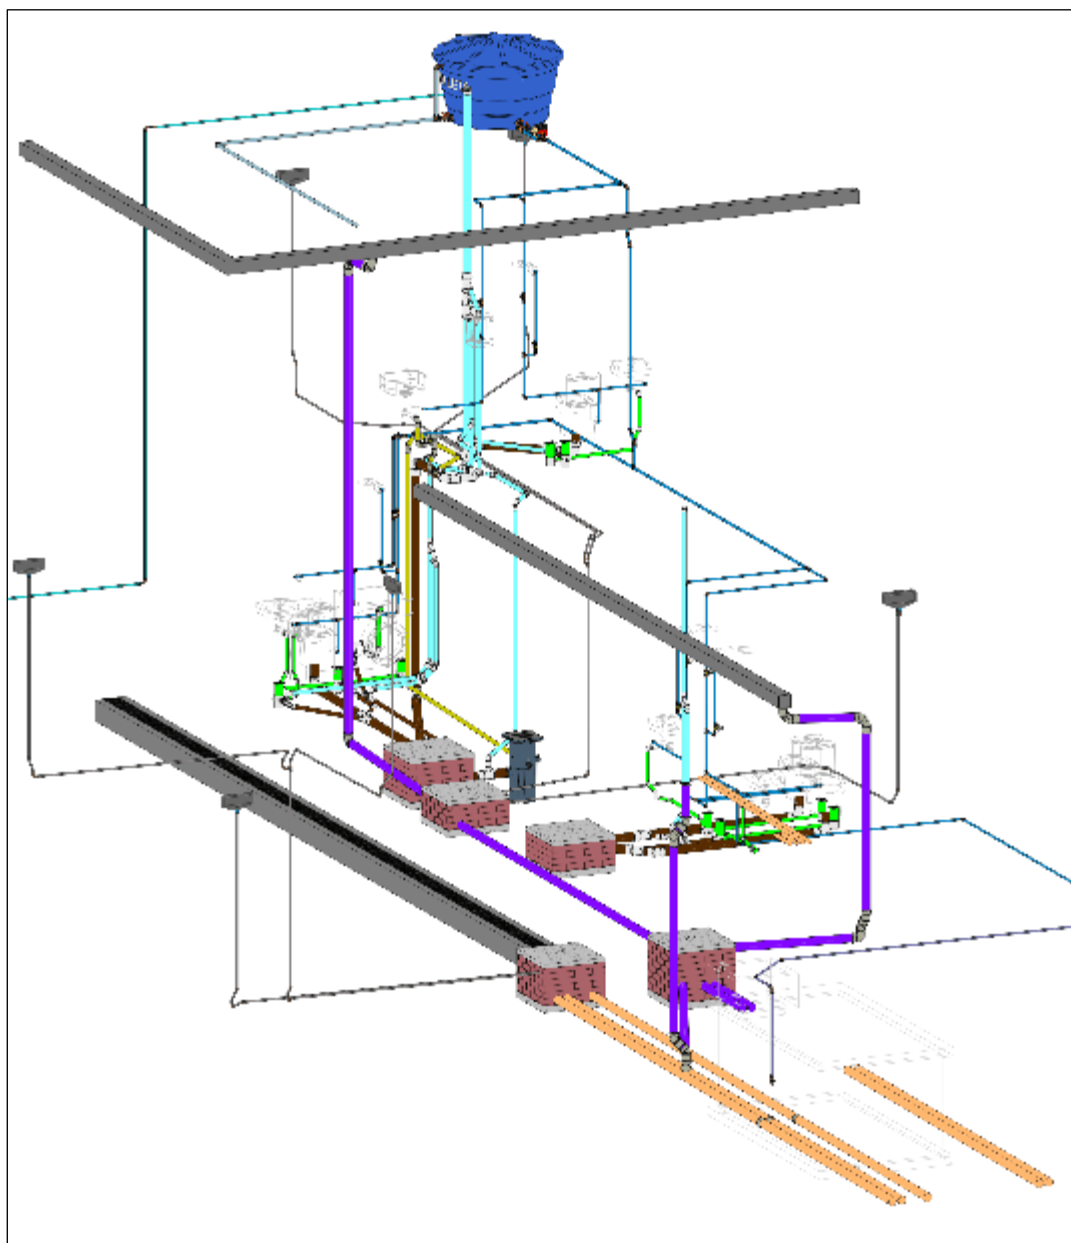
Vista Isométrica de um segmento do Projeto Hidrossanitário Executivo.
